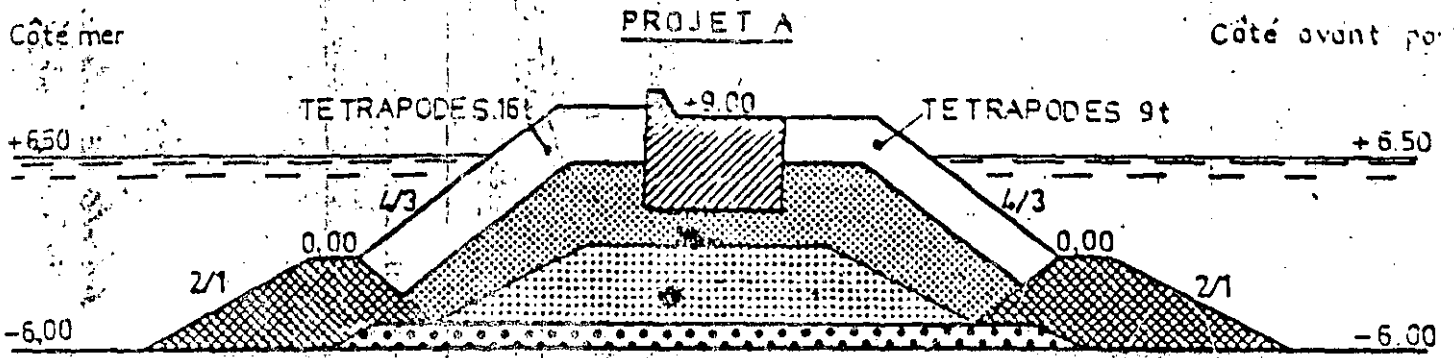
COUPE-TYPE DE LA JETÉE OUEST
